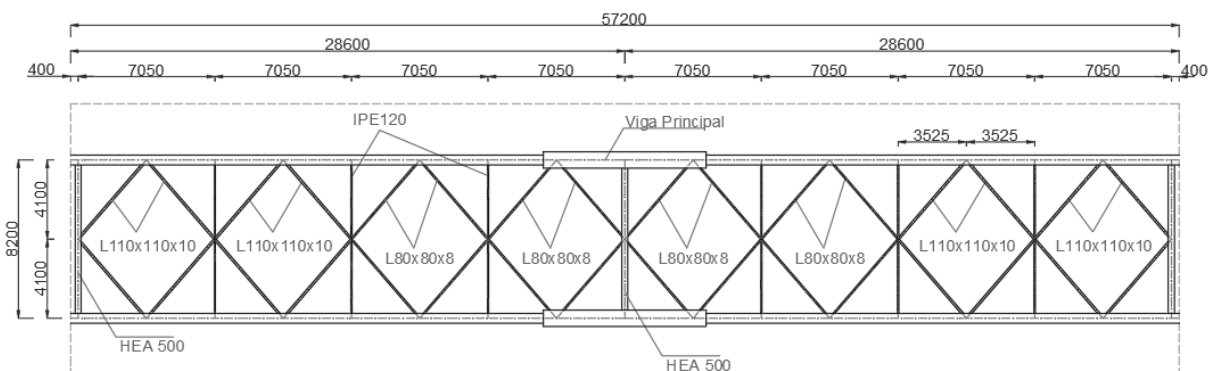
Esquemática do posicionamento dos contraventamentos do tabuleiro misto aço-betão (dimensões em milímetros)
